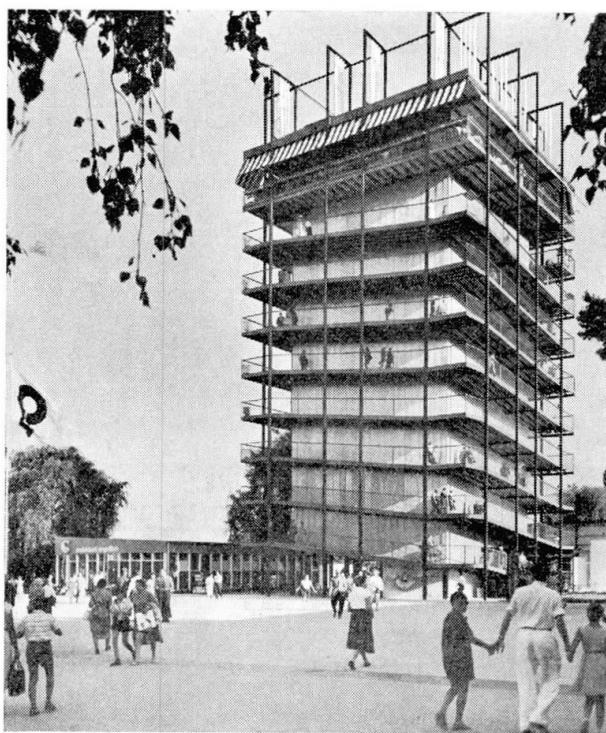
Ausstellungs-Turmhaus der SAFFA, Zürich. Unverkleidete Stahlkonstruktion.
